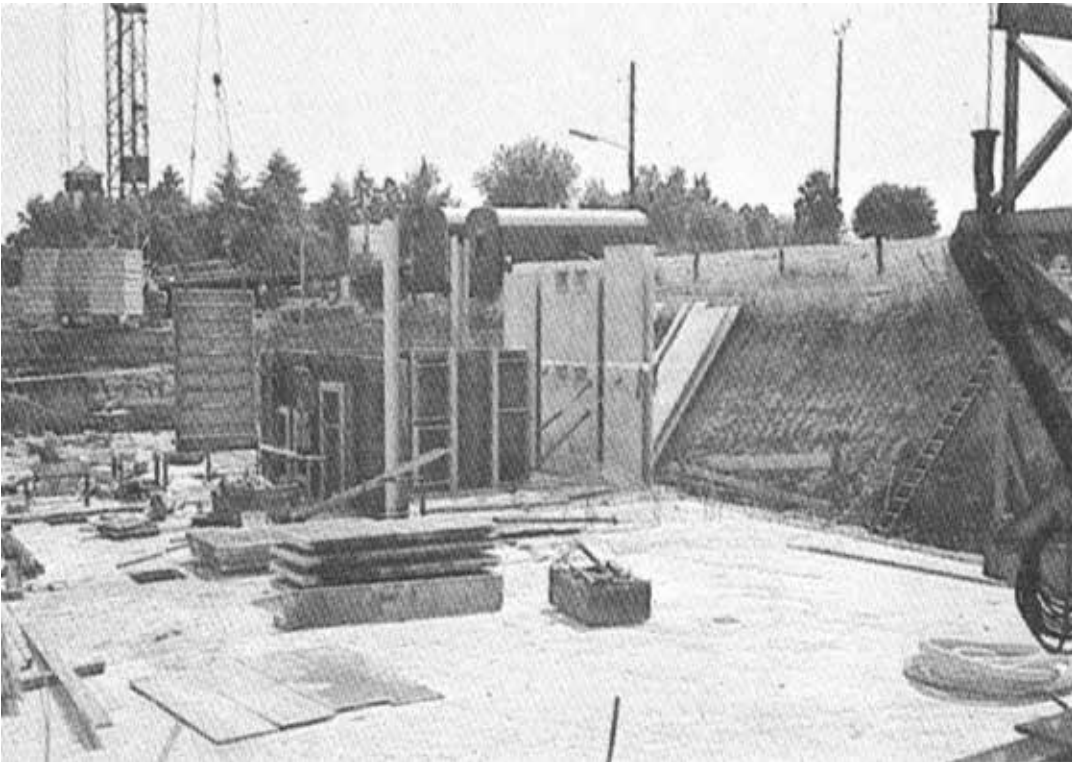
HG-Markt im Bau 1982 (Foto Esslinger Bank)
